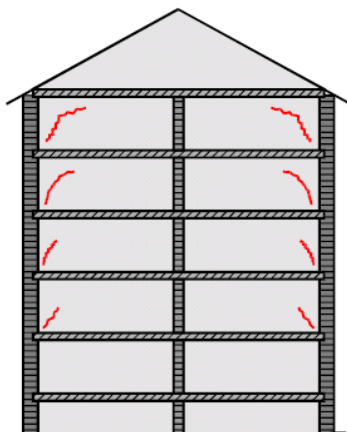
Mauerwerk unter Druckbeanspruchung [Lit 5]
